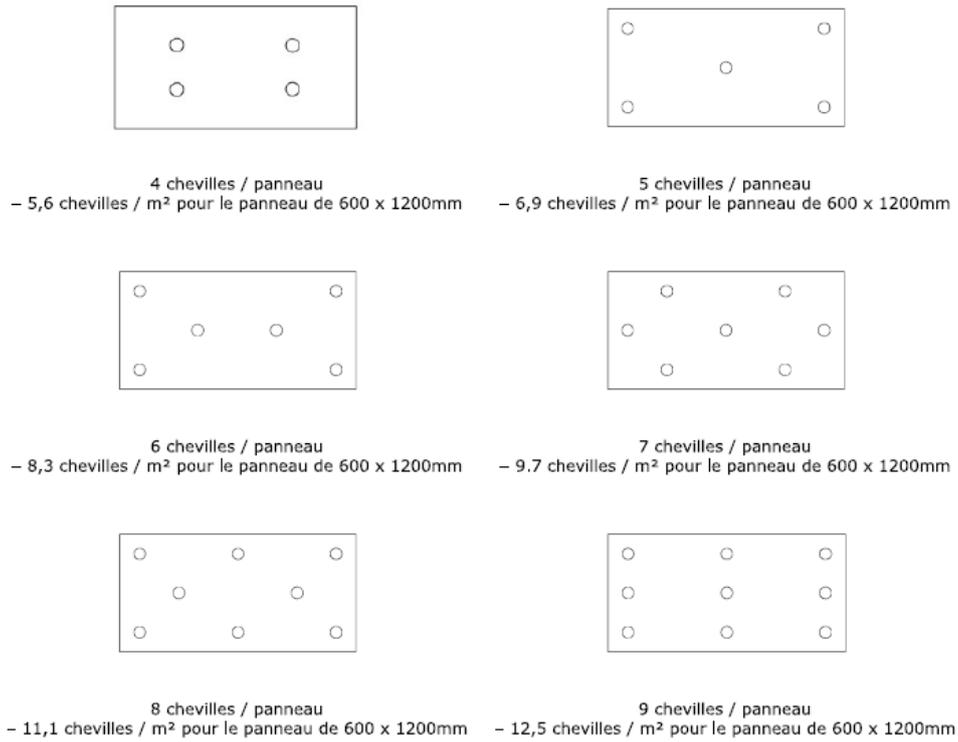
Exemple de plans de fixation sur CLT (1/2)
